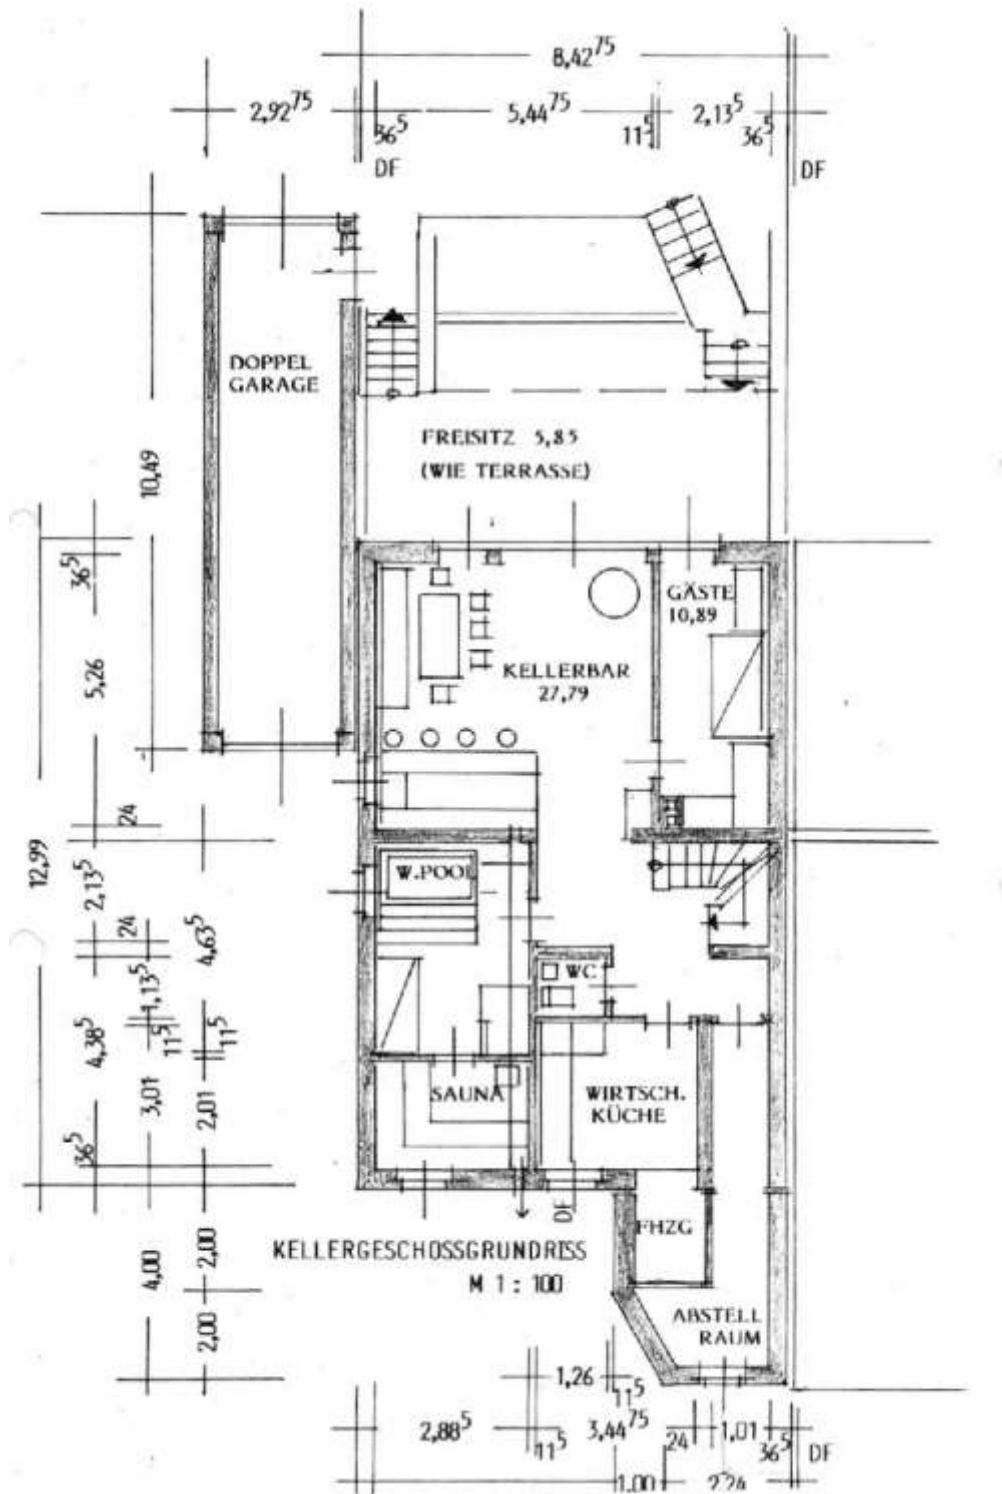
Grundriss KG Quelle: Unterlagen der Gläubigerin
